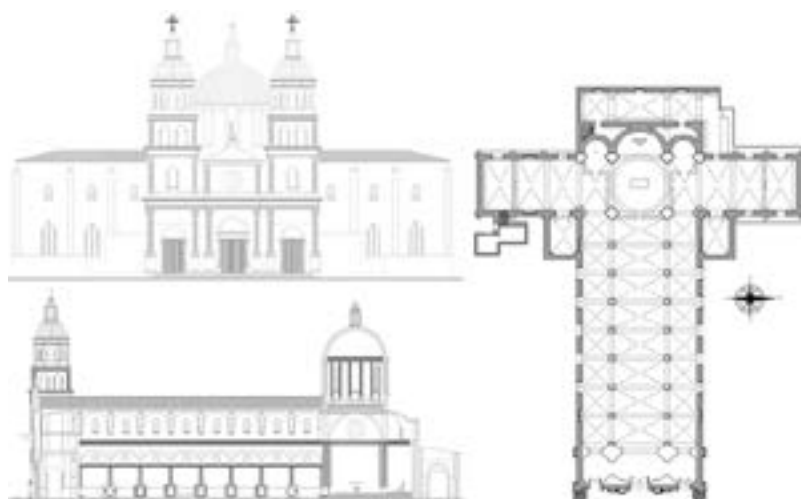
Planimetría de la Catedral de San José de Cúcuta. Fuente: elaboración propia.
